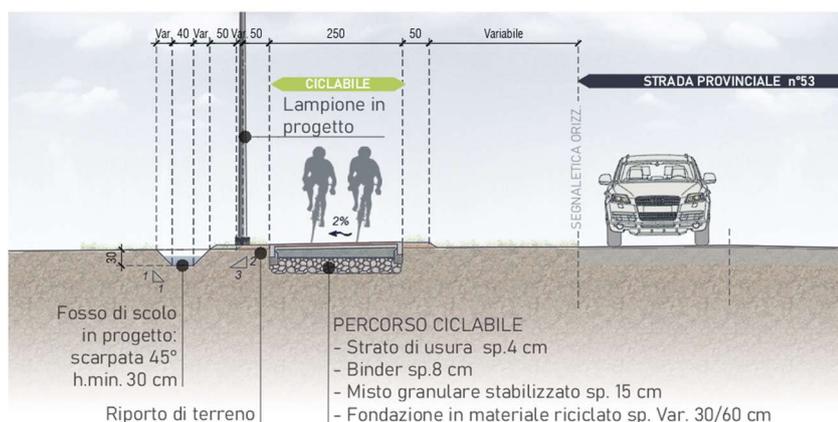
Sezione tipo su area verde con pavimentazione in conglomerato bituminoso drenante semiaperto
